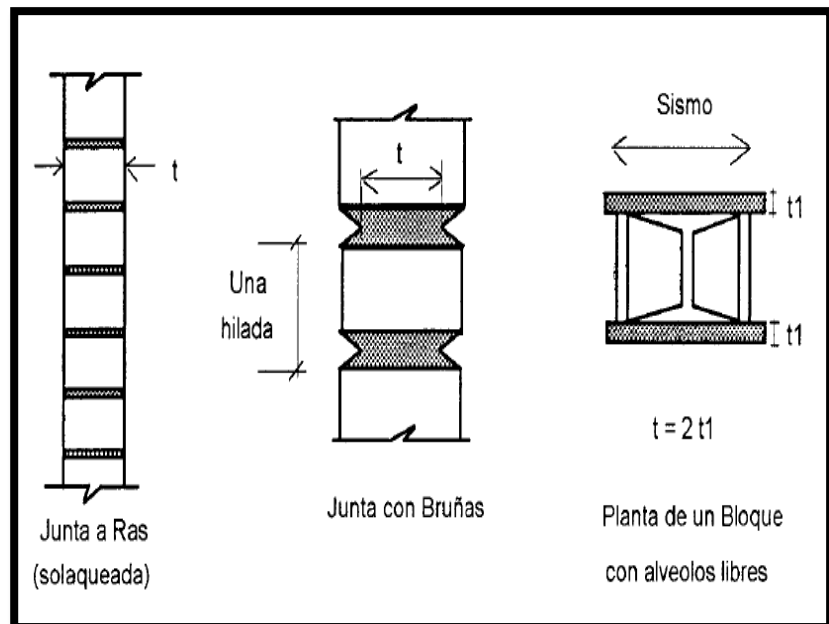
Espesor Efectivo de un muro. (Fuente: Ángel San Bartolomé, "Construcciones de Albañilería-Comportamiento Sísmico y Diseño Estructural").
